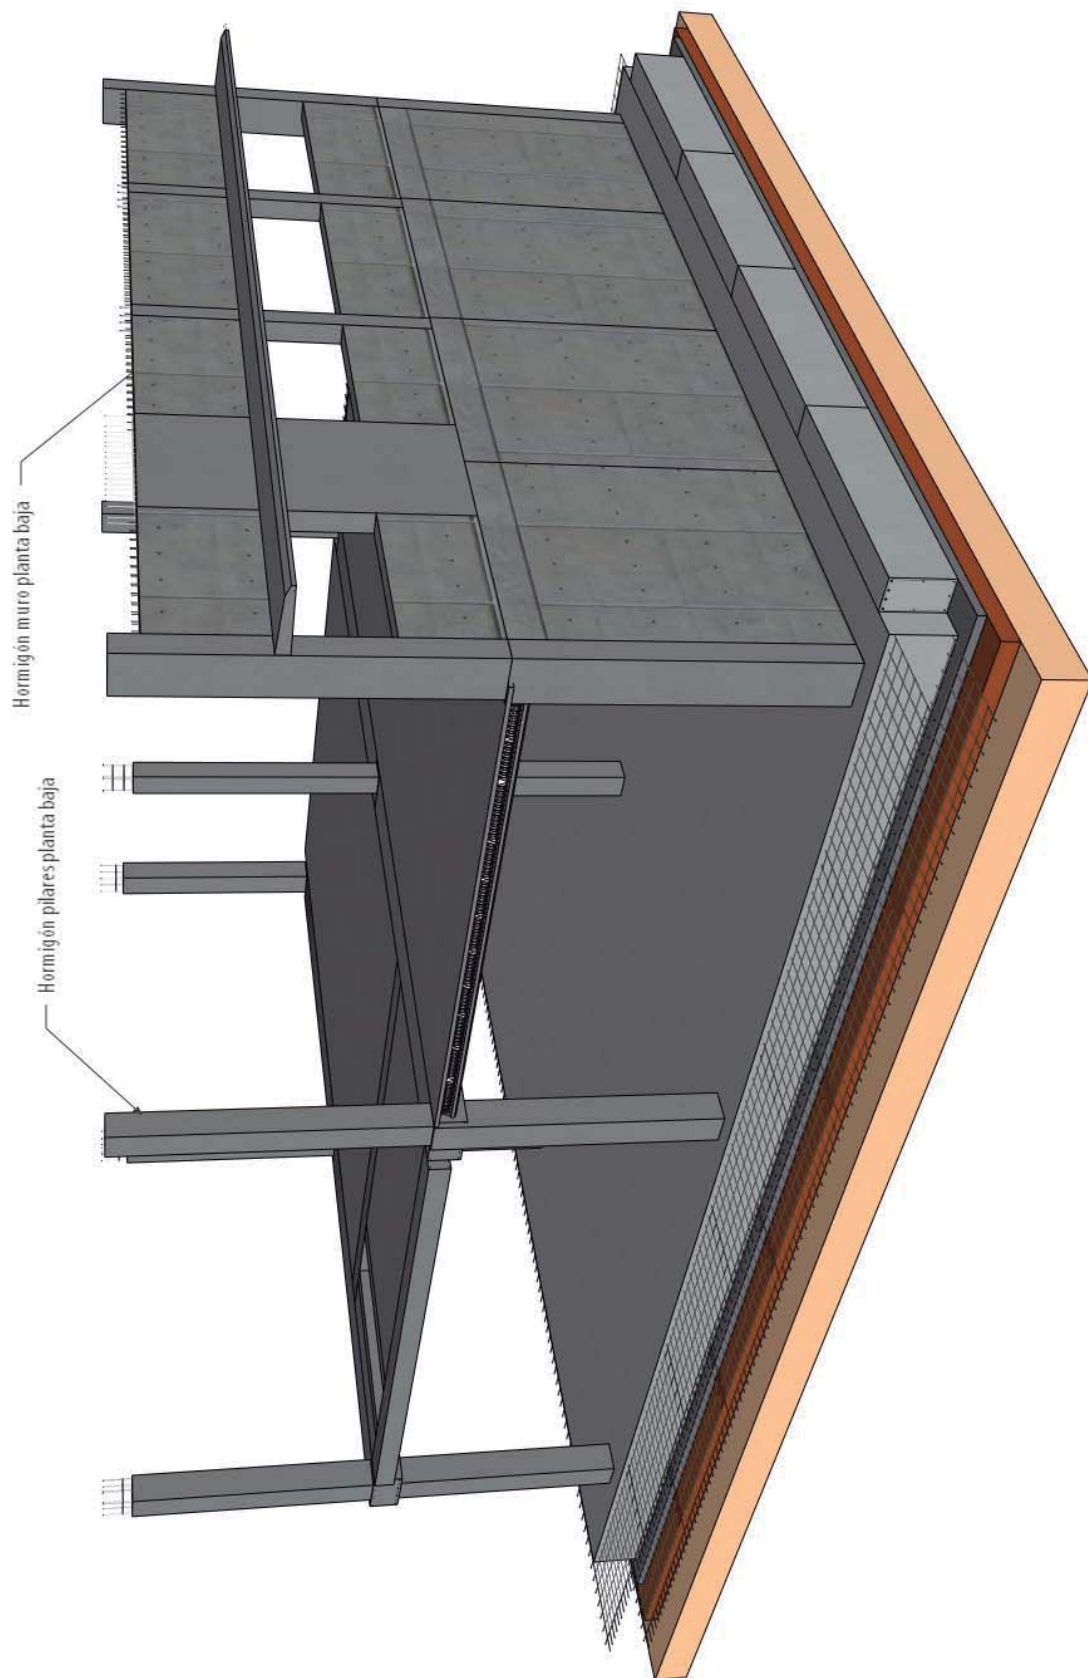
Hormigonado de los pilares de la planta baja y del su muro
